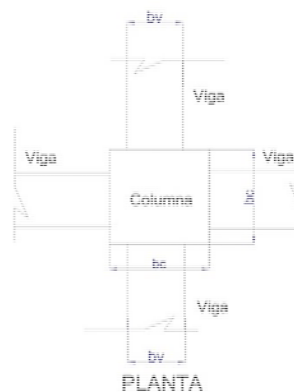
Relación ancho columna (bc) y ancho viga (bv) (A. Medina, 2013).
